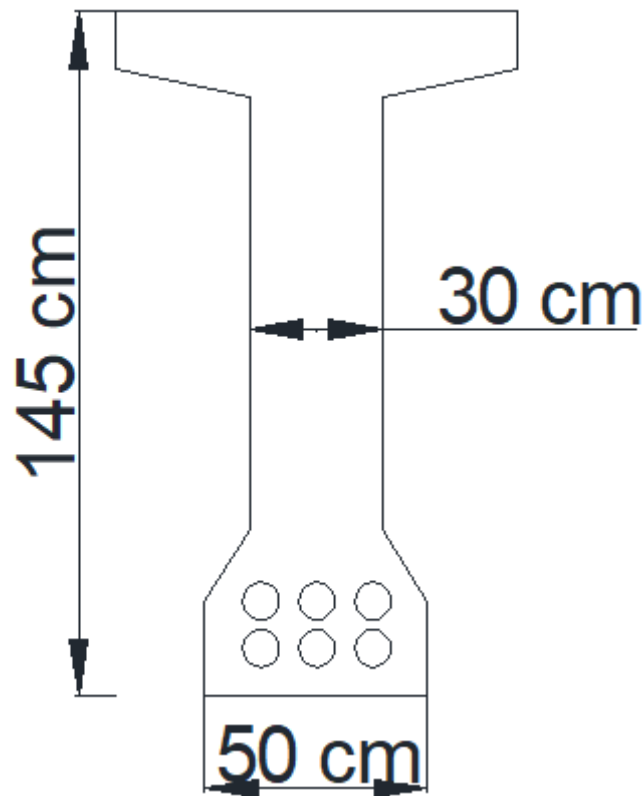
Position du câble moyen à la section médiane de la poutre.
